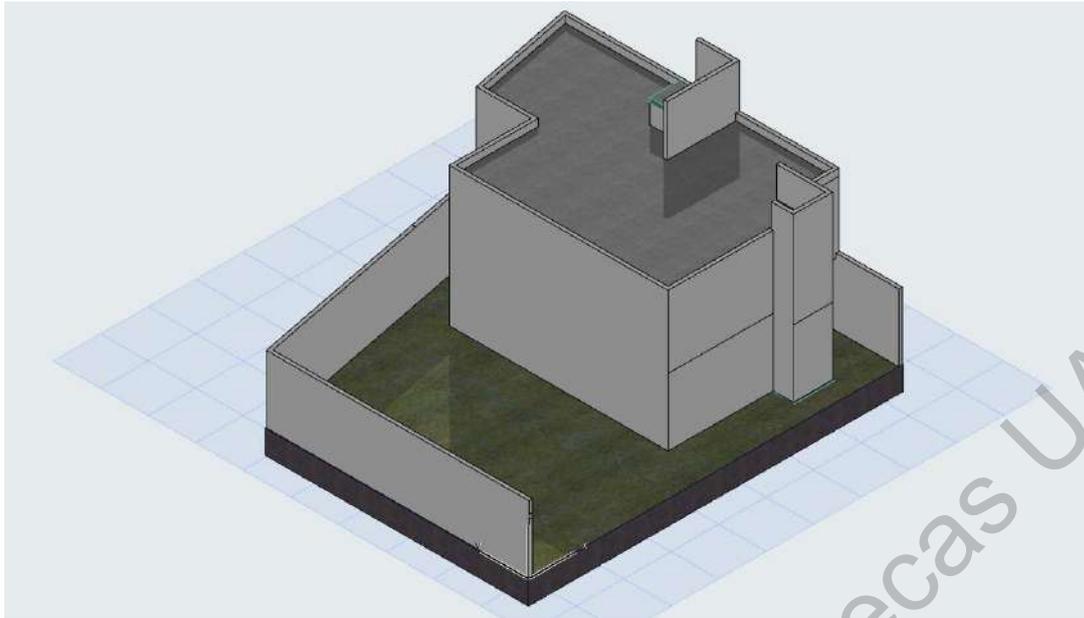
Suelos/Rampas de Planta de azotea del proyecto 001.
